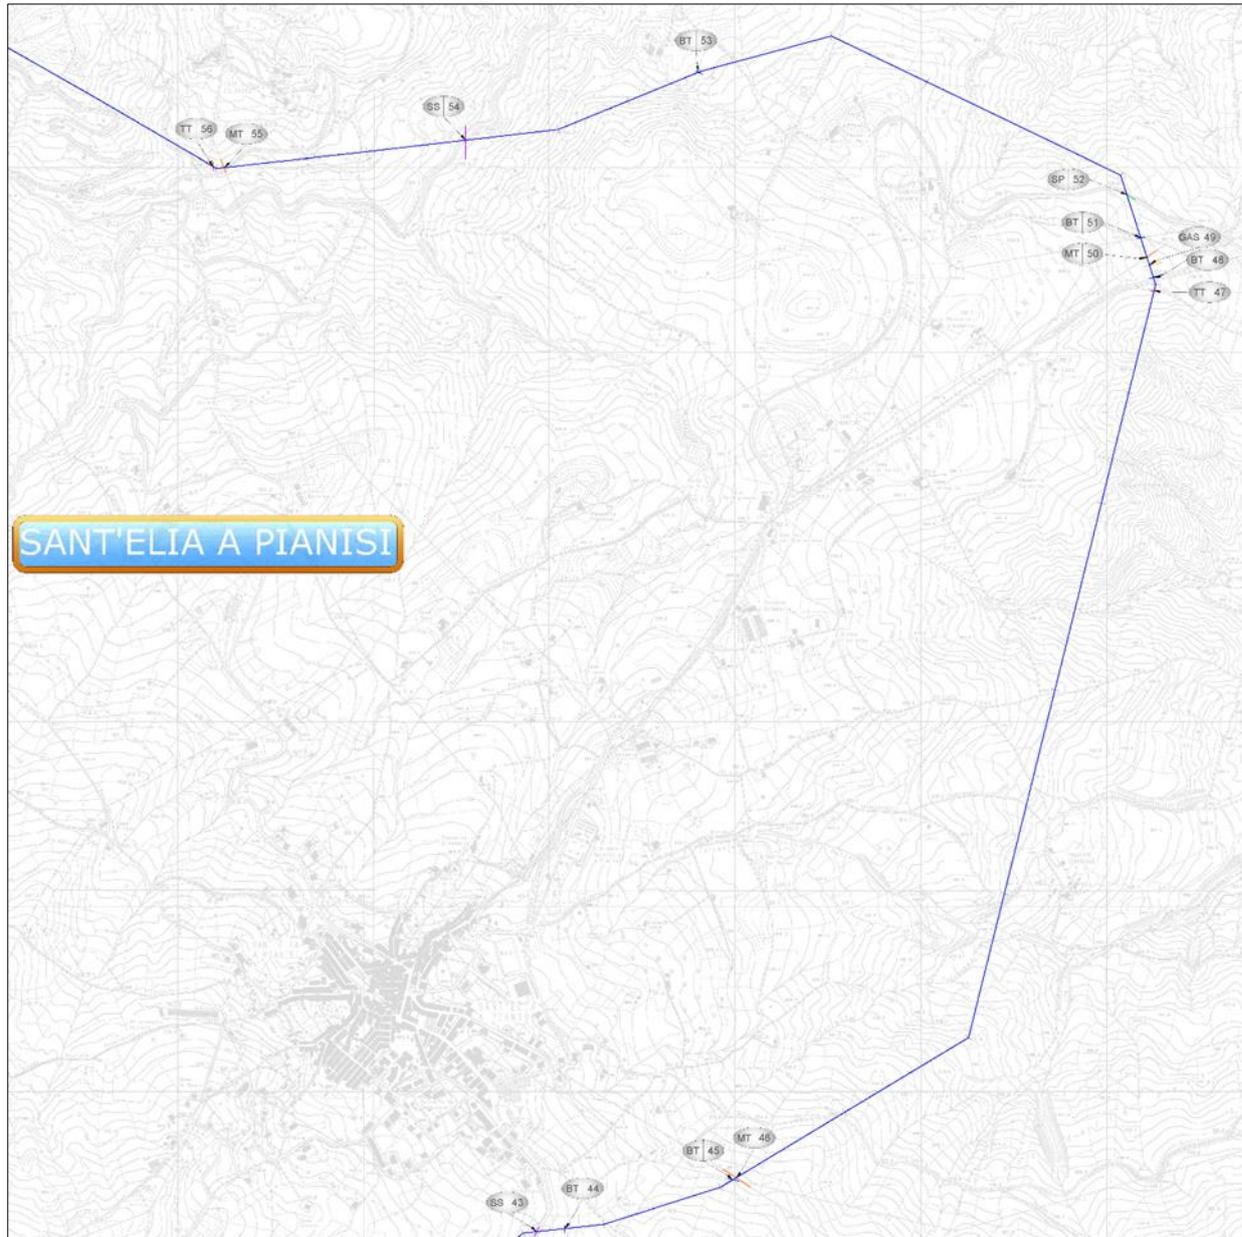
Stralcio planimetria tracciato elettrodoto su CTR (3/5)
